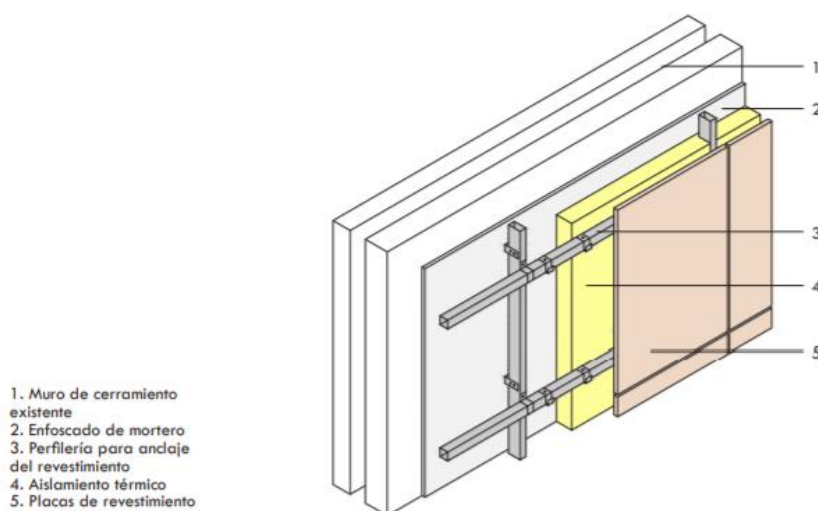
Detalle da estrutura dunha solución de fachada ventilada <sup>53</sup>
